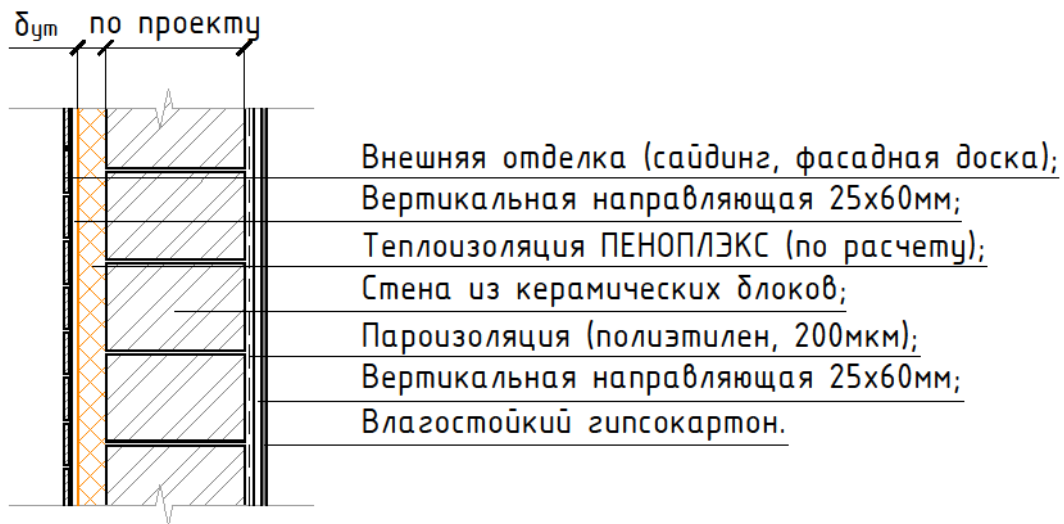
Схема внешней отделки фасадной доской/сайдингом.
